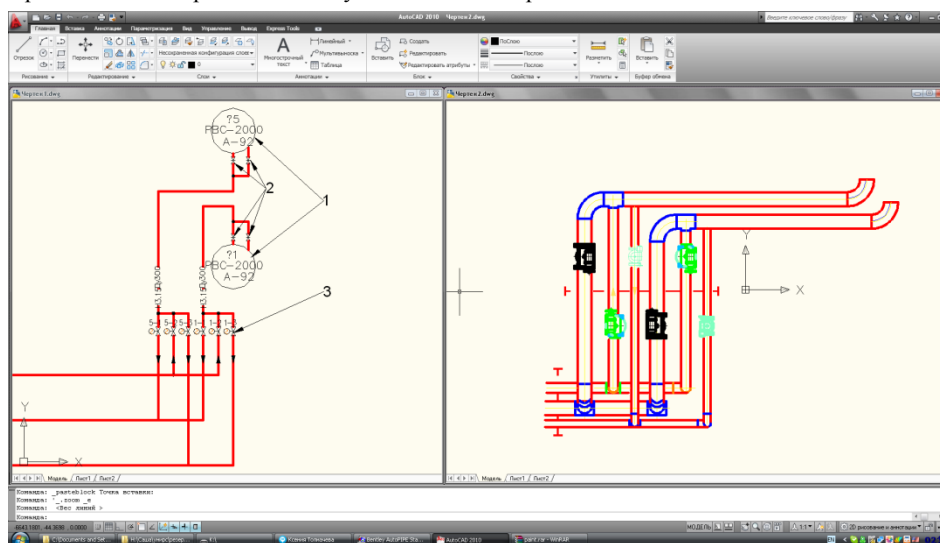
Технологическая схема и схема узла участка трубопровода:
